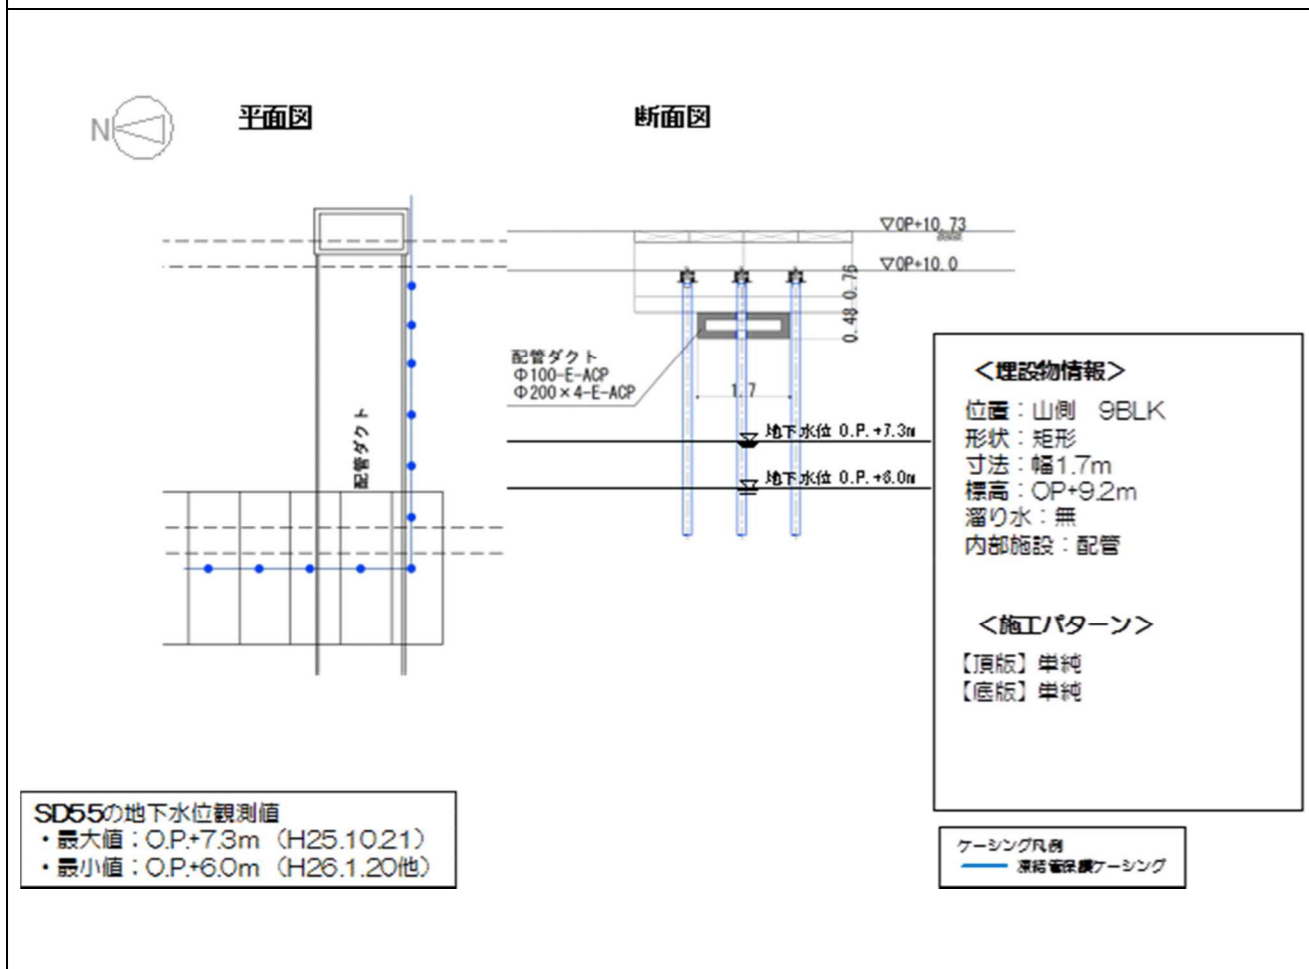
【9-2】配管ダクト 施工方法 (貫通施工)
